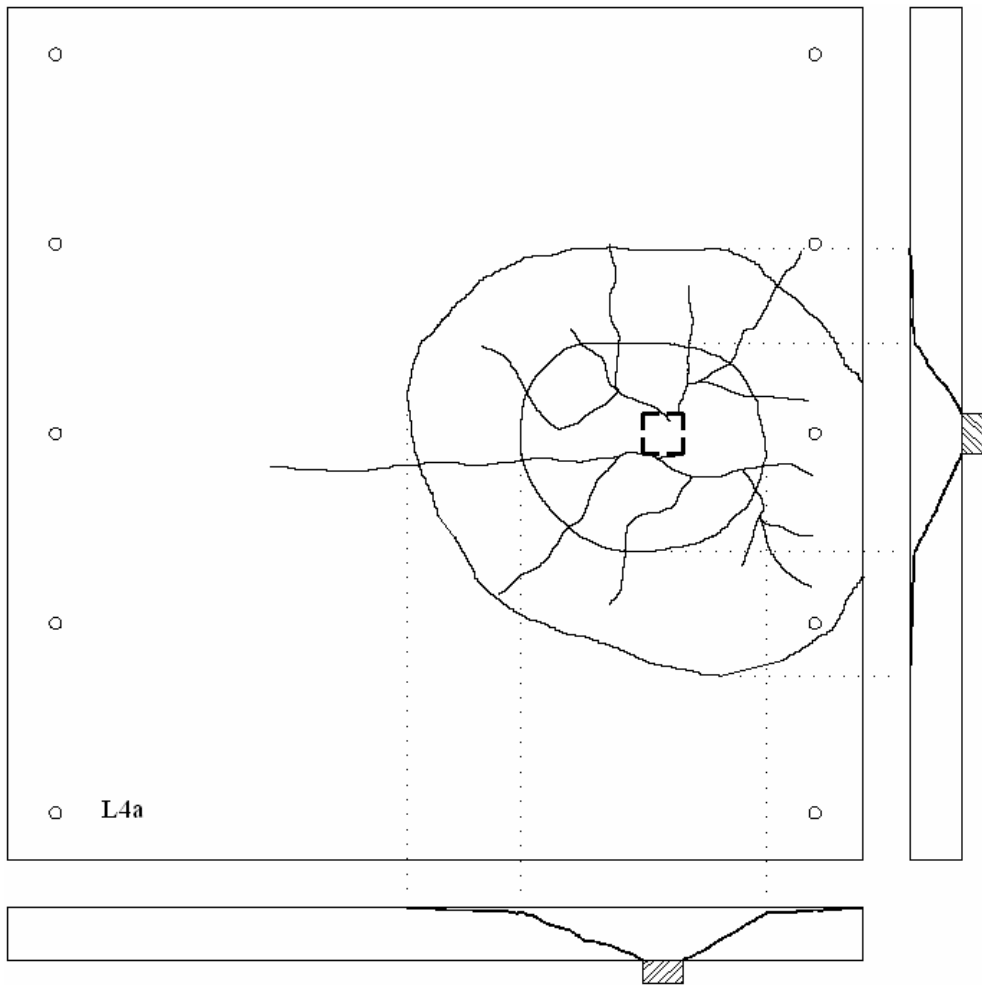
Mapa de fissuração da laje L4a
